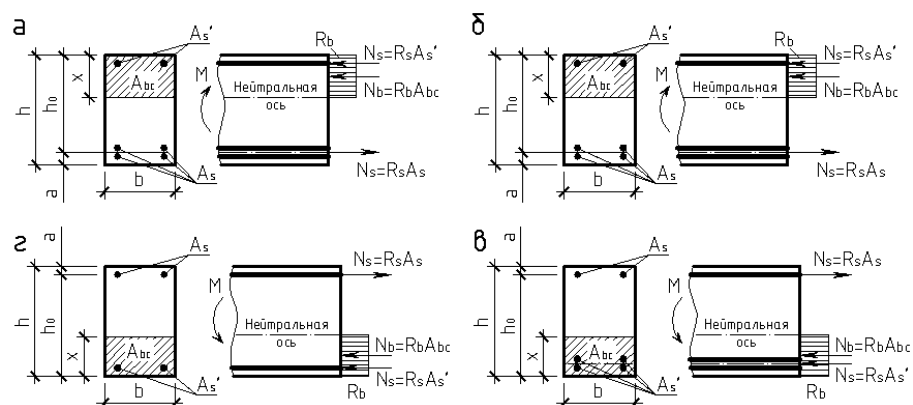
Схема внутренних усилий в ригеле, армированном двойной арматурой;
